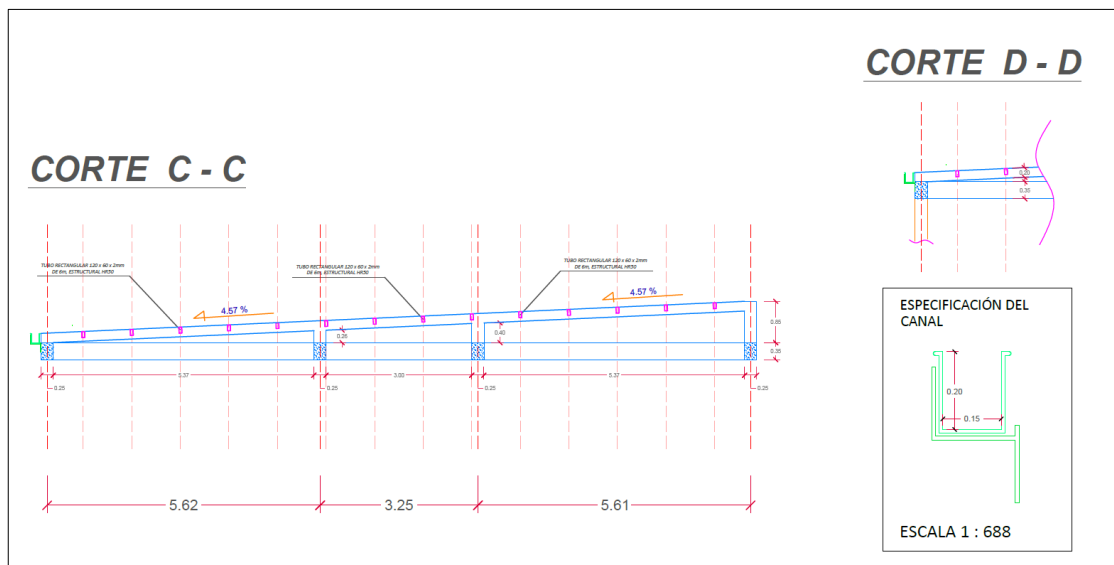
Corte arquitectónico C-C y D-D, de la estructura 1 del Centro de Desarrollo Infantil.
